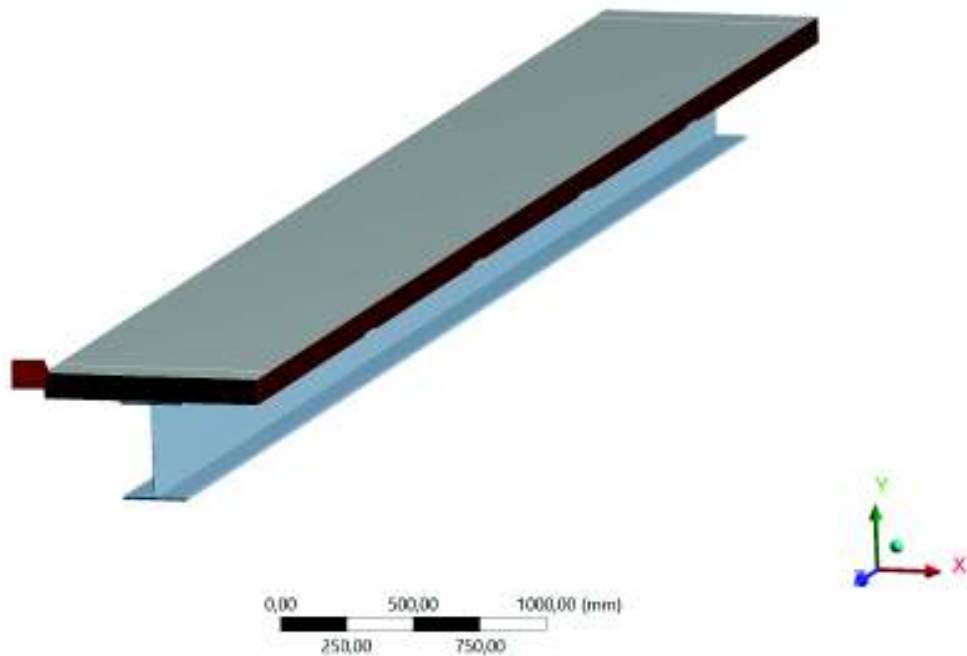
Restricción de los desplazamientos en las caras de la viga metálica VT4
